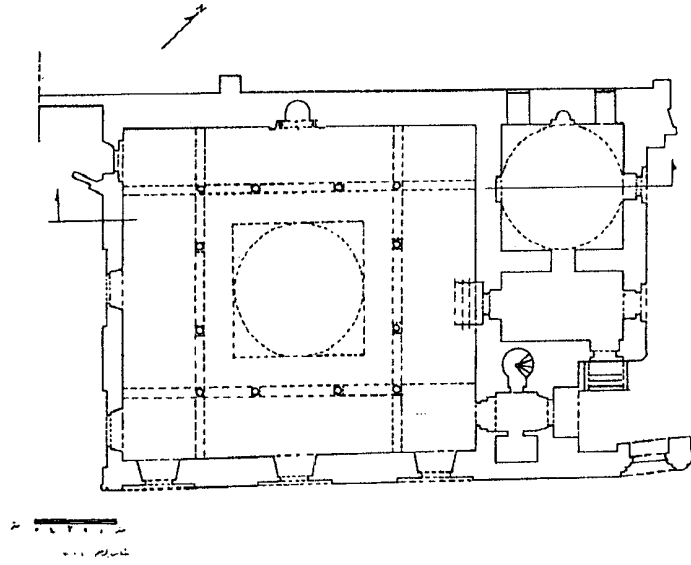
مسقط أفقي لمدرسة أيتمش الجاسي بالقاهرة
